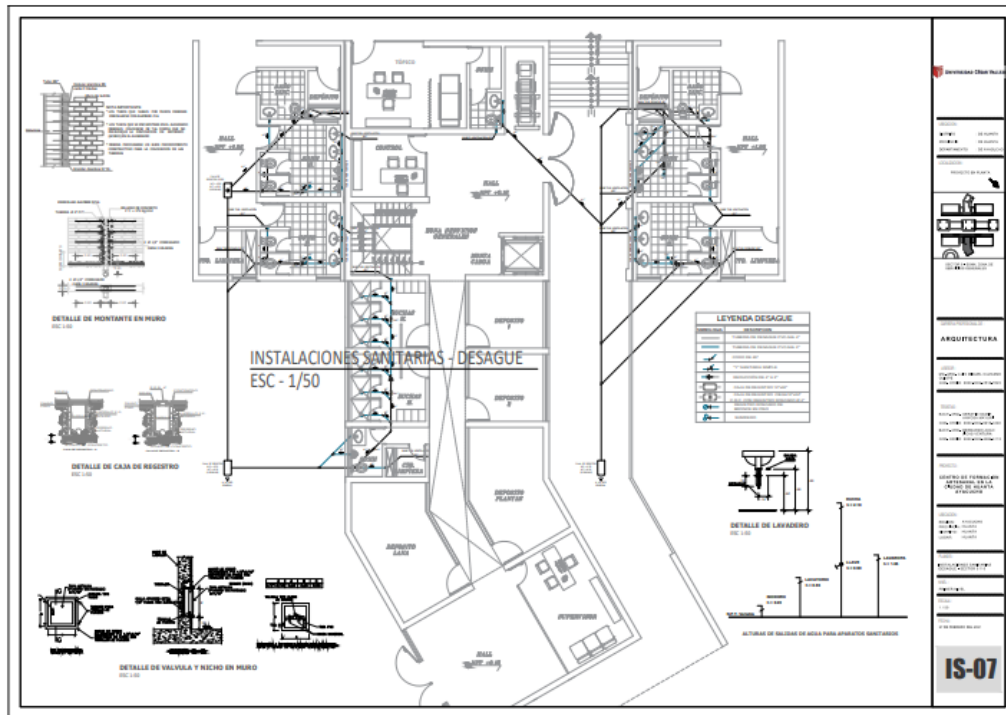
Plano de instalaciones sanitarias desagüe piso 1 - escala 1/50.
